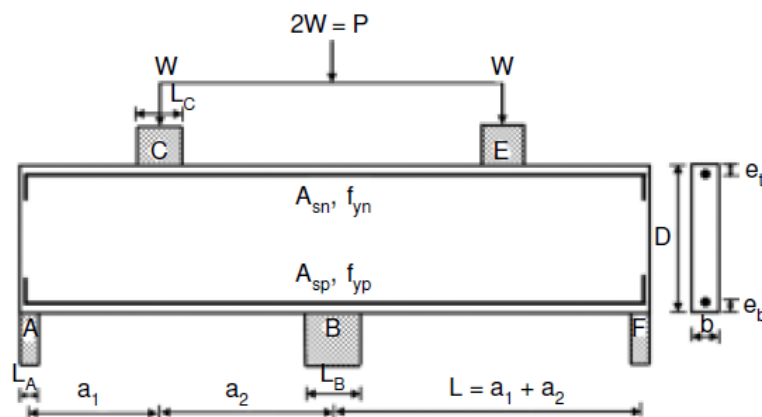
Detalhe de uma viga contínua com dois vãos sujeita a duas cargas concentradas (NAGARAJAN; PILLAI, 2009).
